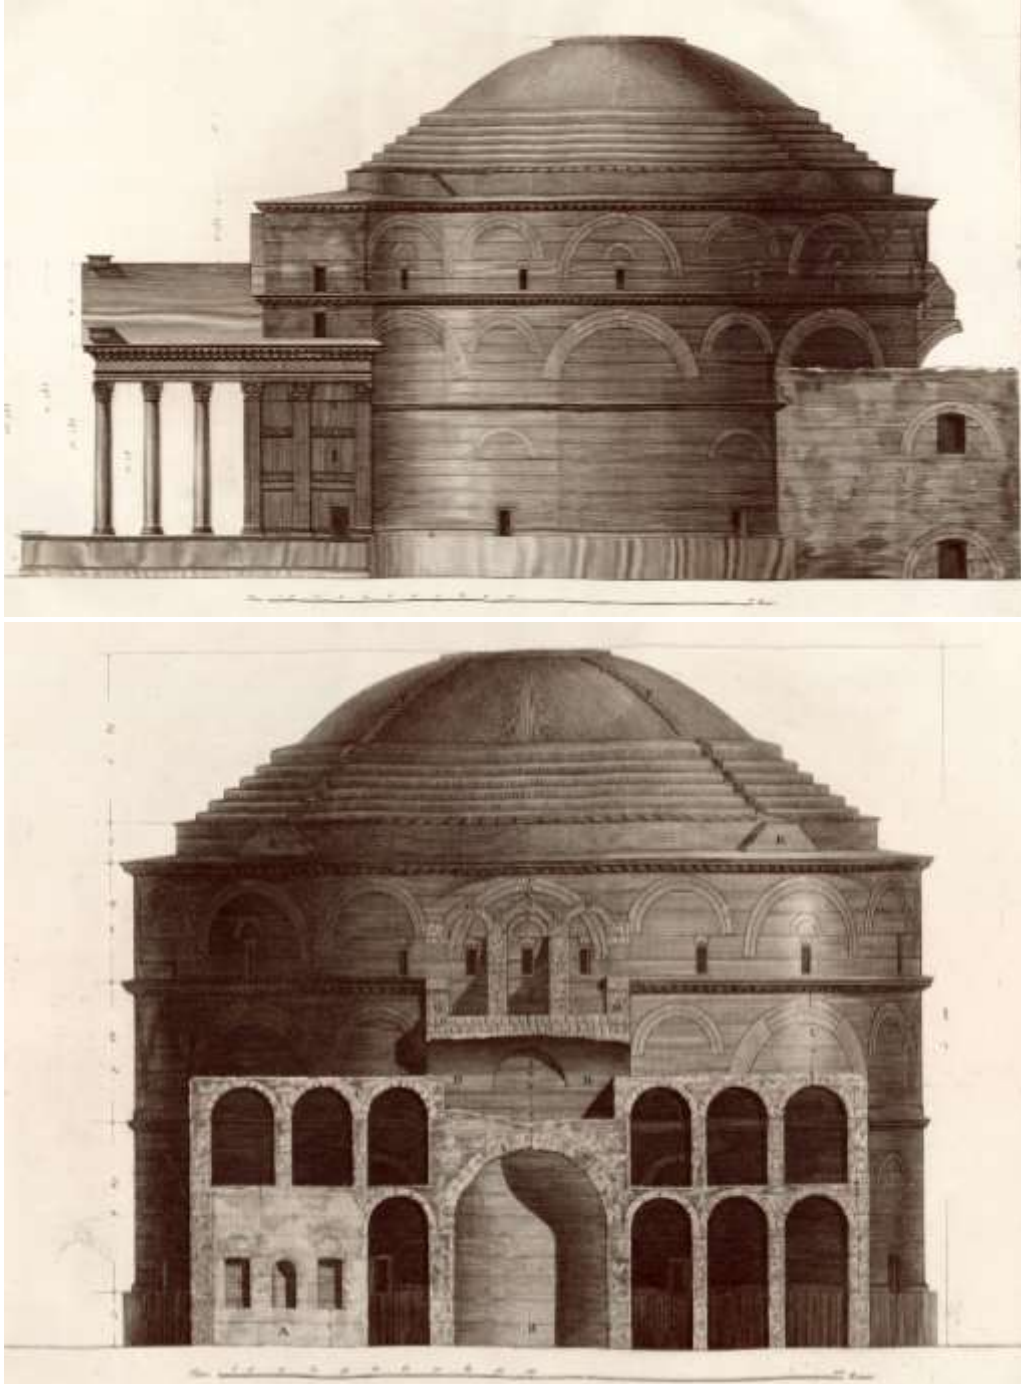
Prospetto ovest e sud - G.B. Piranesi 1756
